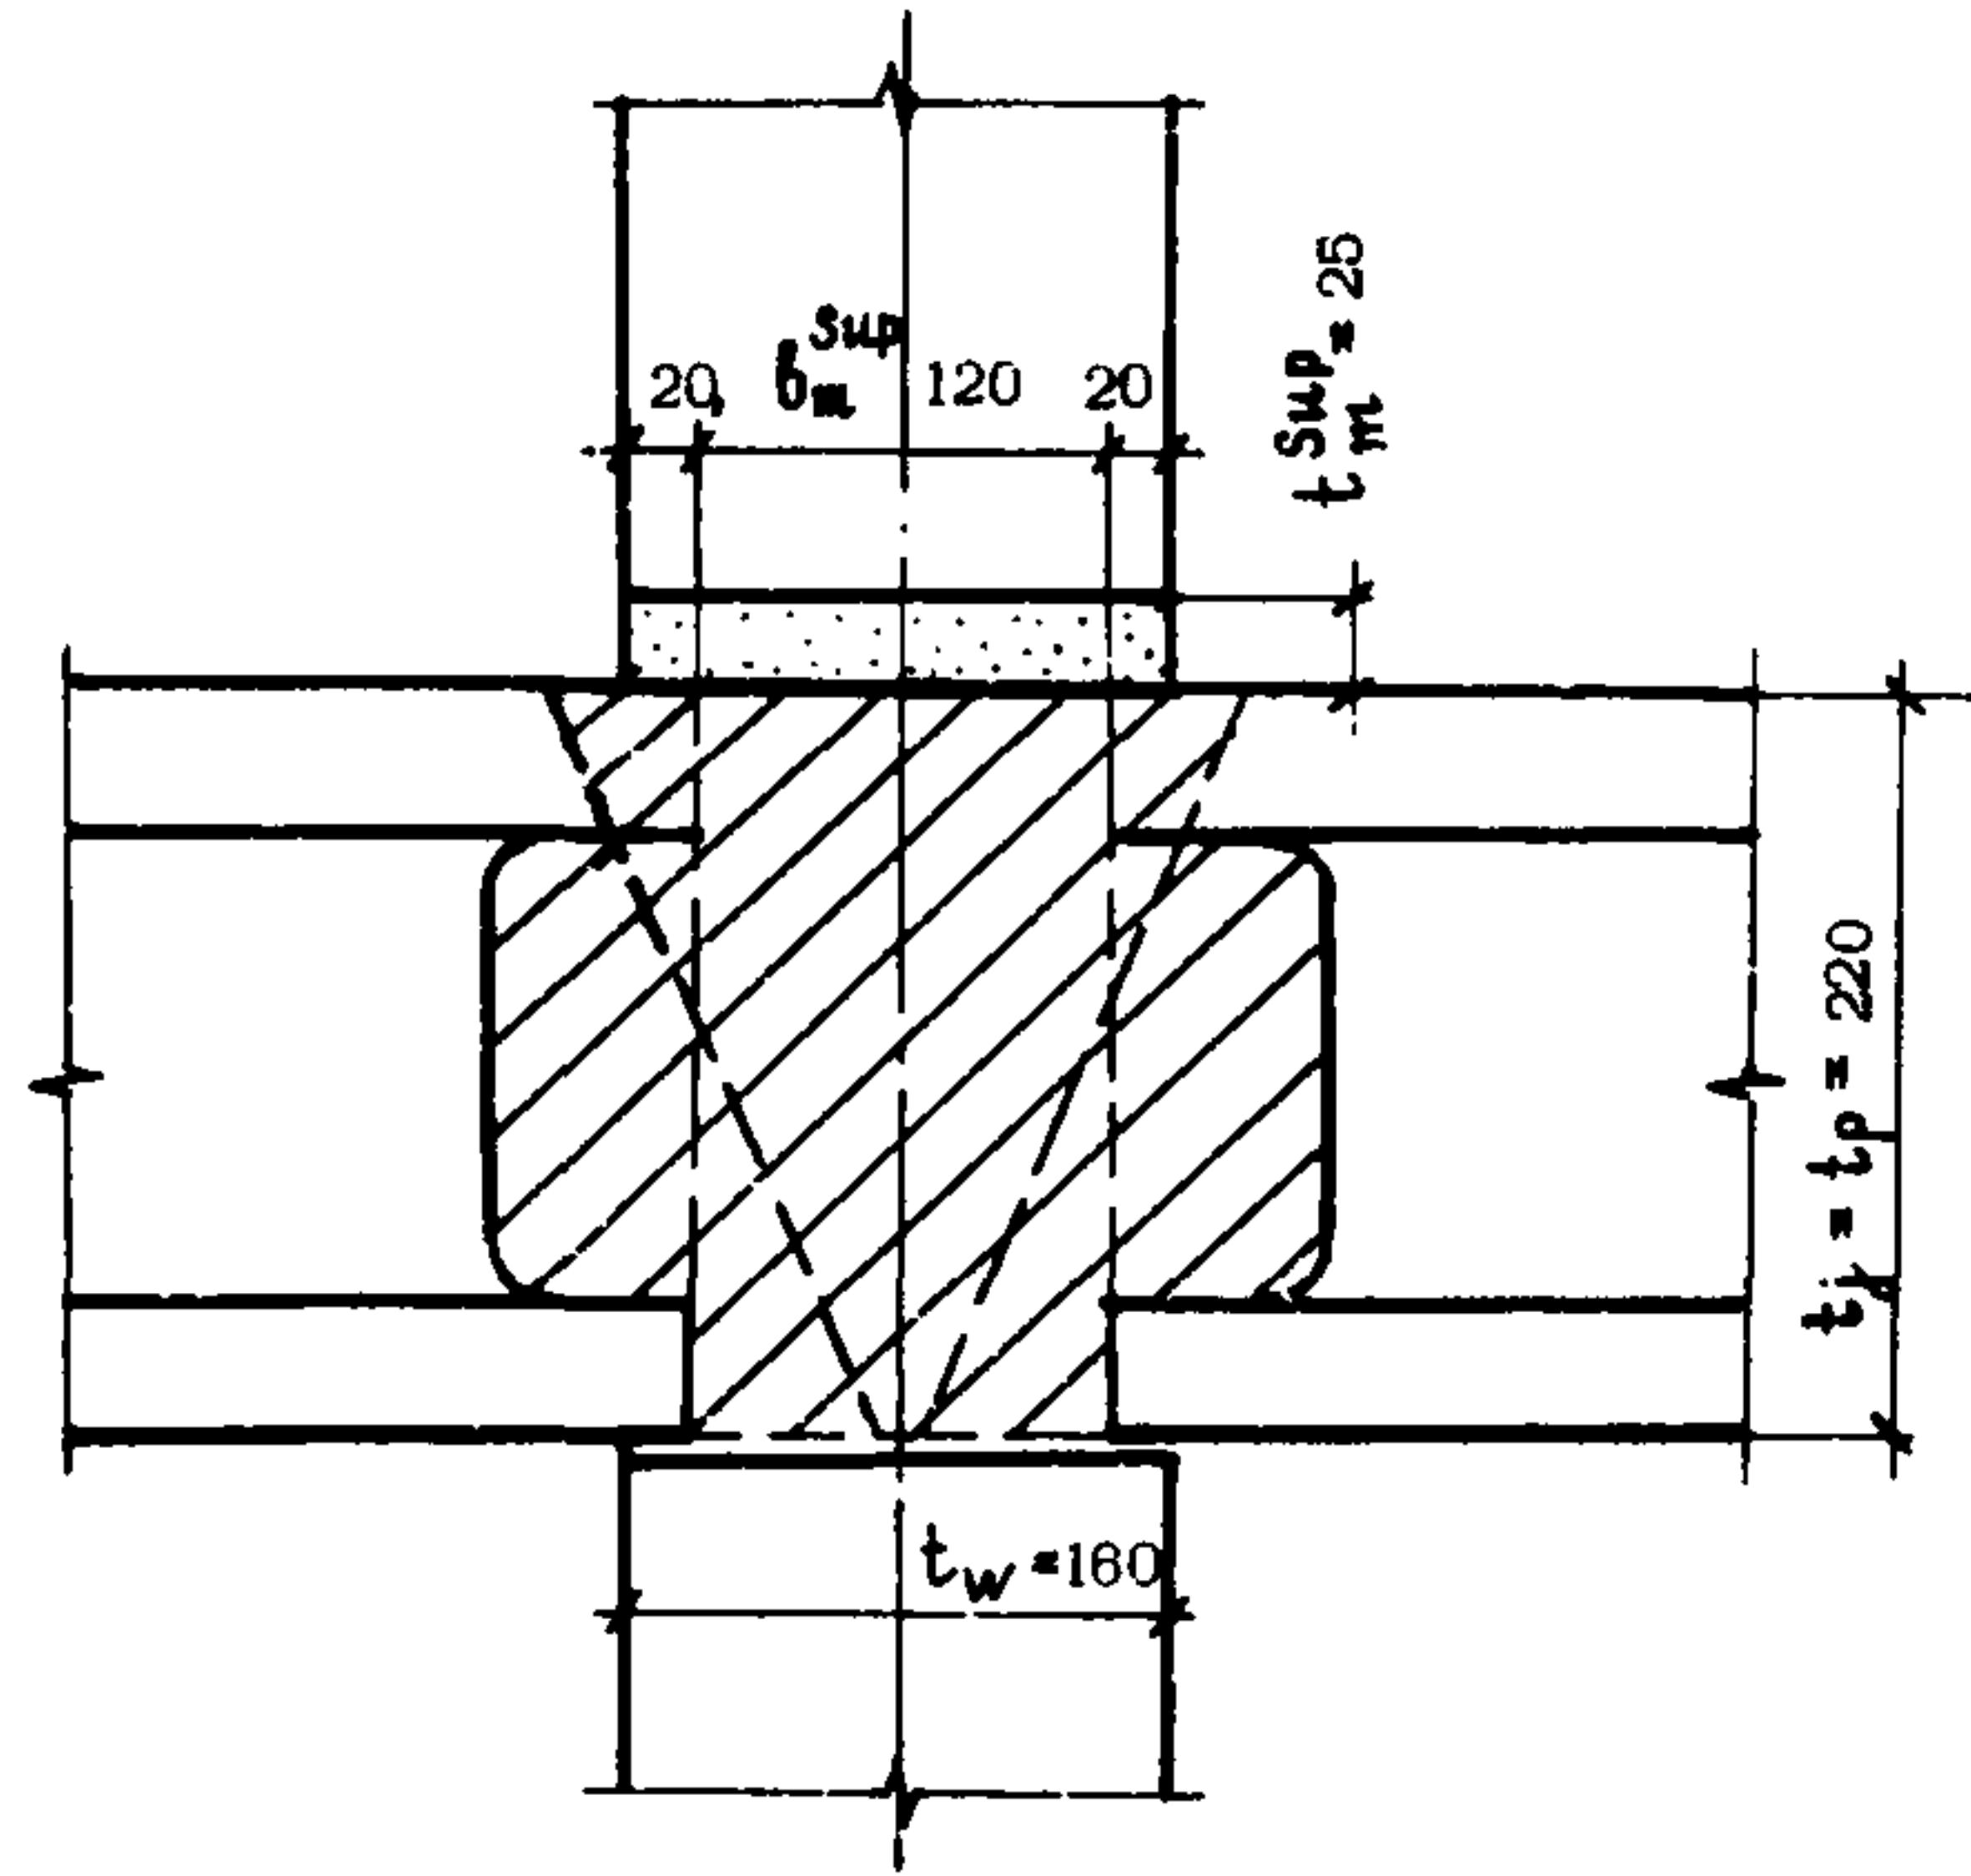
Монолитный стык внутренней панельной стены при двустороннем опирании плит перекрытий (к примеру 5)
